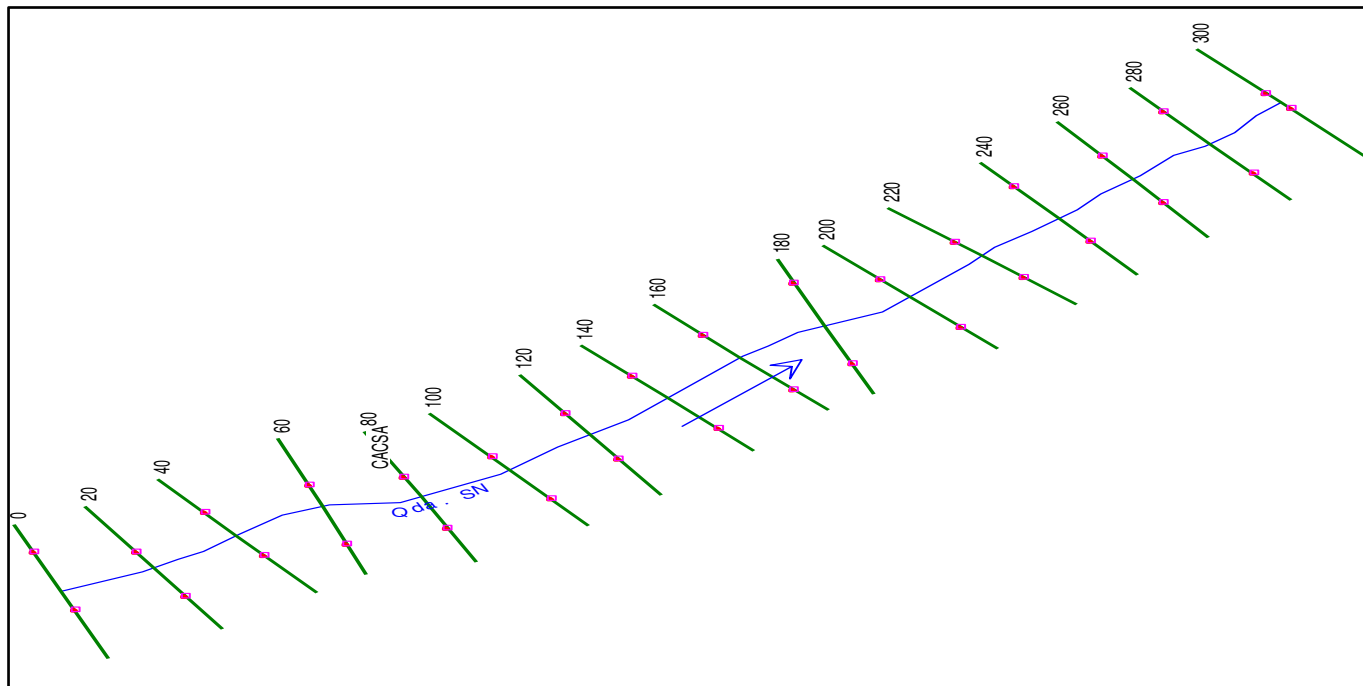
Planta de Qda. Sin Nombre en el área del proyecto
